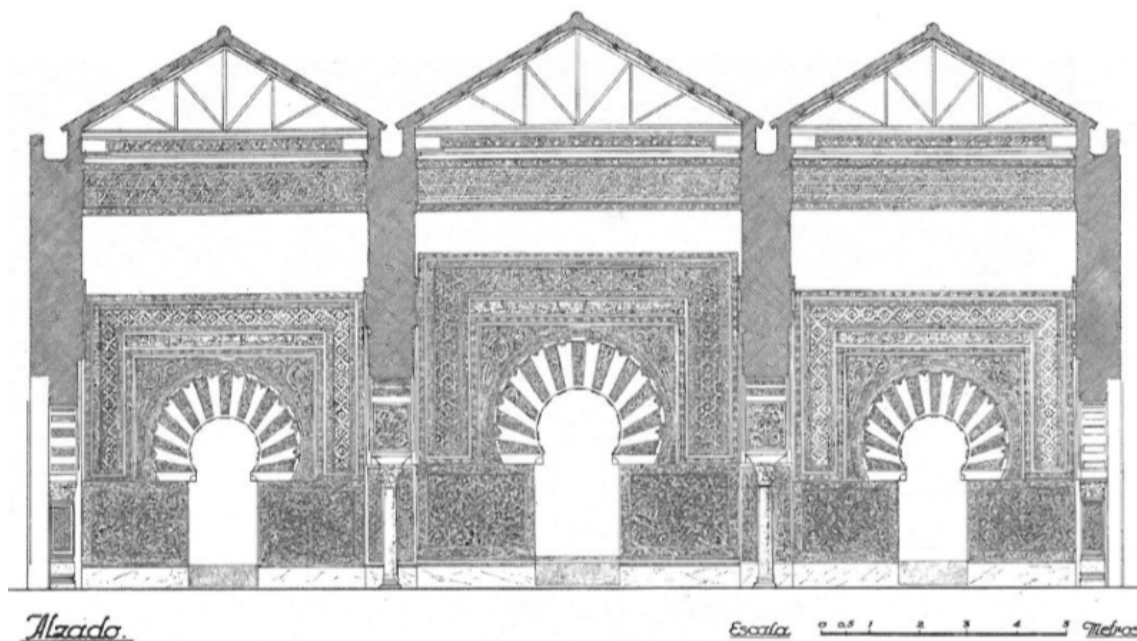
Córdoba. Medina Azahara. Alzado de la propuesta de reconstrucción de Félix Hernández donde puede verse la solución planteada en las cubiertas (Vallejo, 2010: 46).
